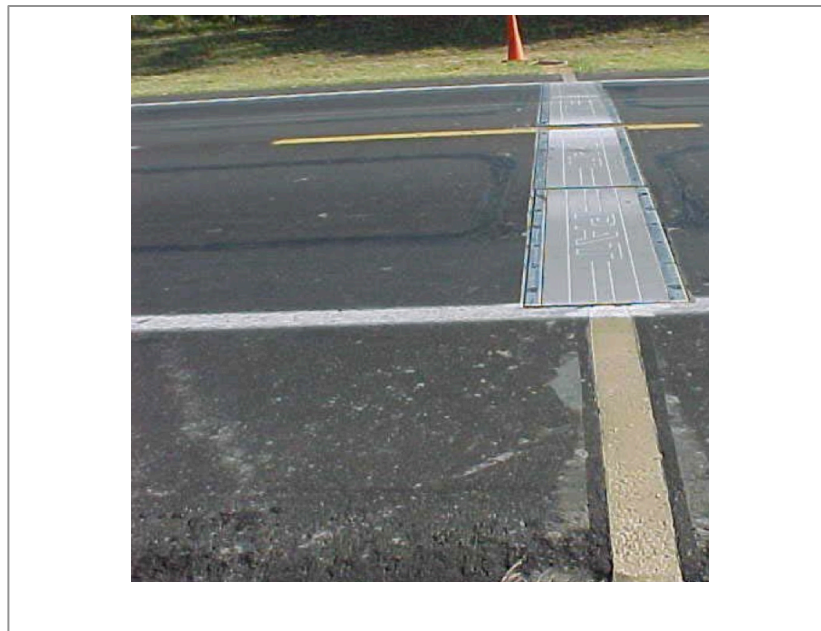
Placa en flexión (Florida Department of Transportation, 2007)
